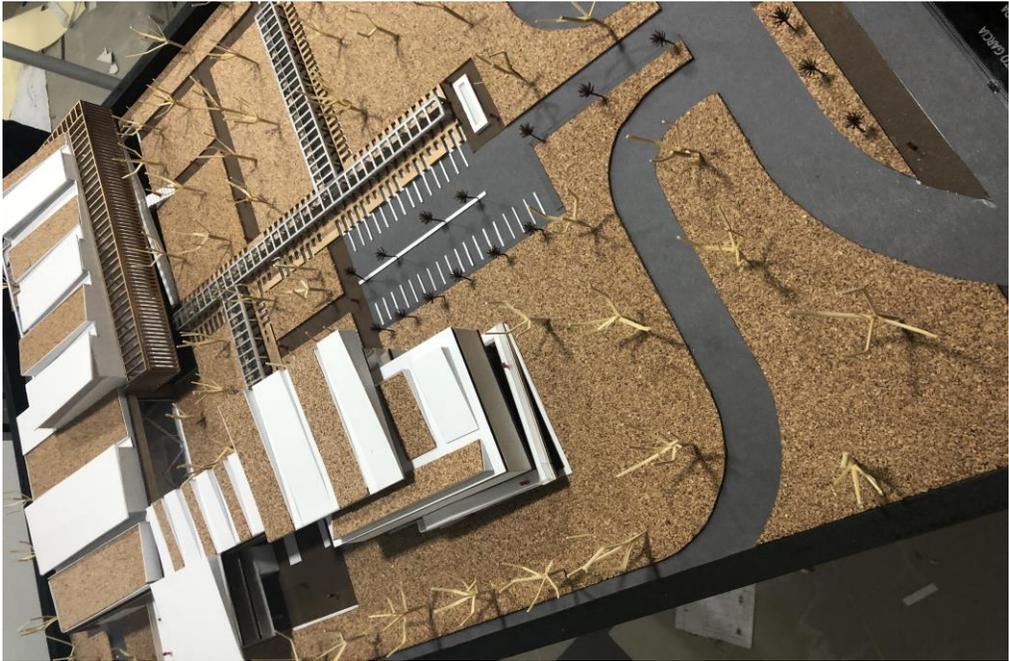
Foto de la cubierta de la maqueta. Fuente: Elaboración propia.
